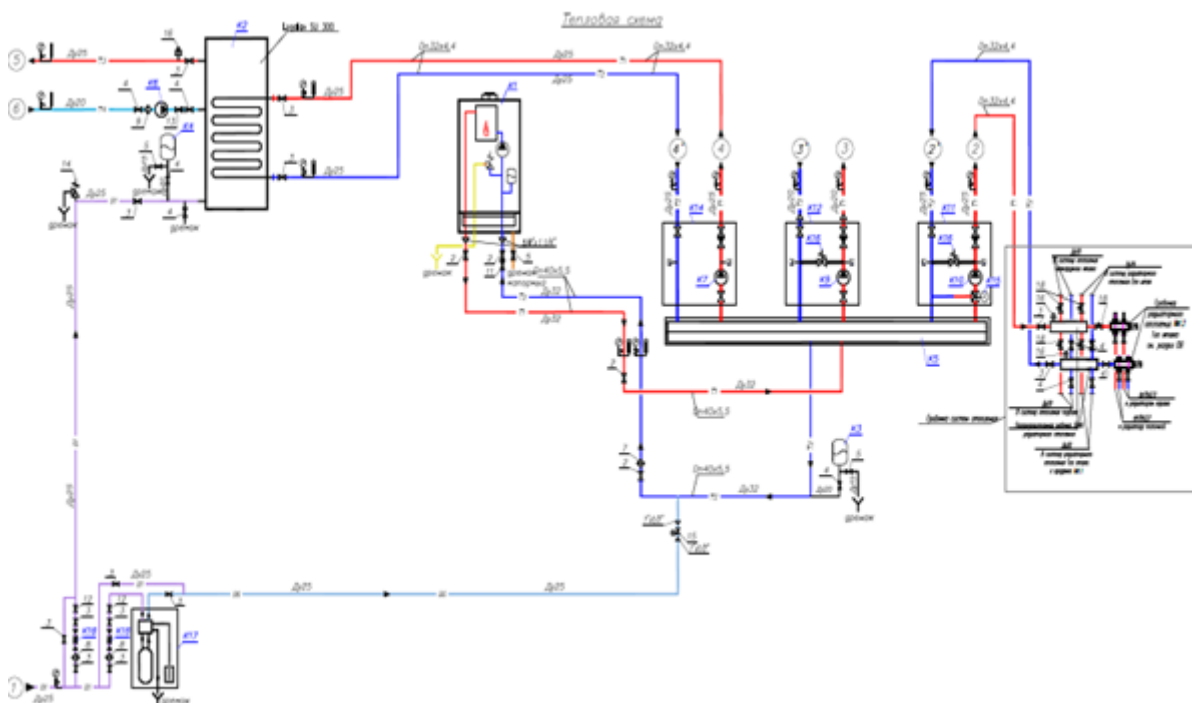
Схема індивідуального теплового пункту будинка
